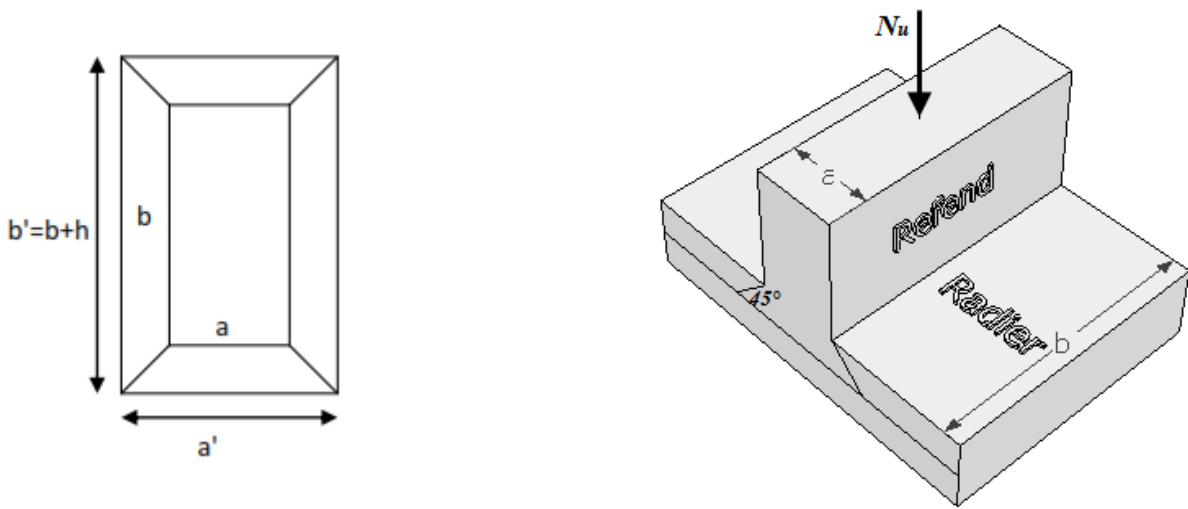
Périmètre utile des voiles et des poteaux.
